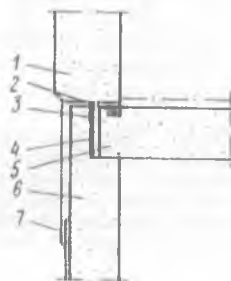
Деталь опирания ячеистобетонного перекрытия на подвальную стену
